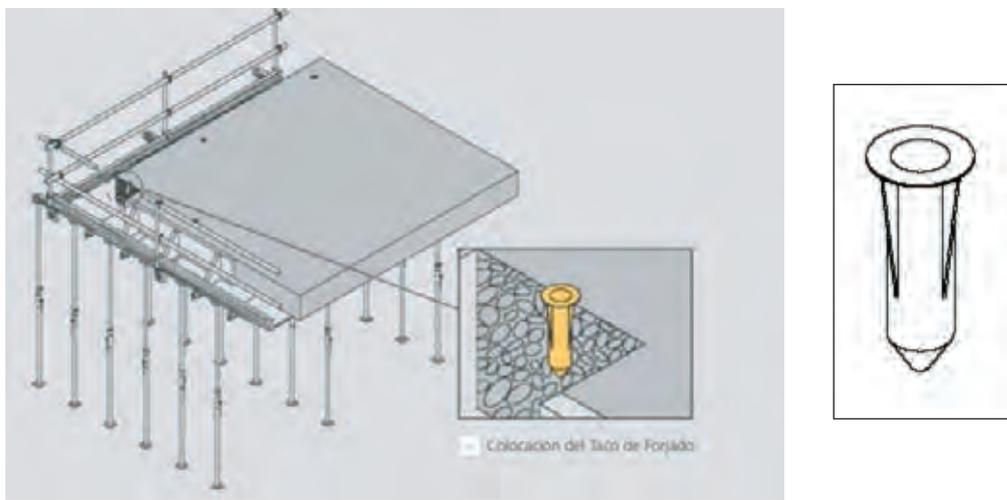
Sistema de fijado al forjado mediante cartuchos. Detalle de la colocación del cartucho en el forjado, y detalle de cartucho para alojamiento de guardacuerpos.
